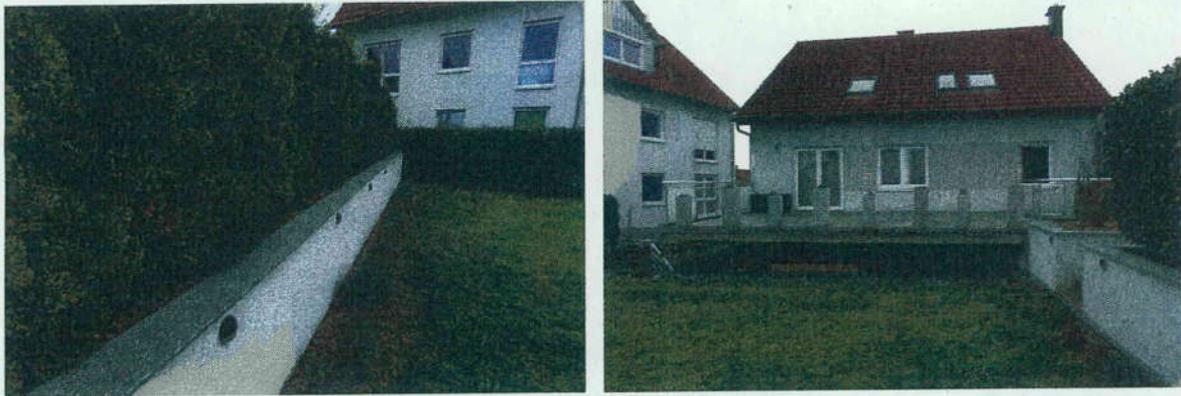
Gartenbereich Einfriedung, Blick nach Süden Bild 14: Ansicht nach Westen
